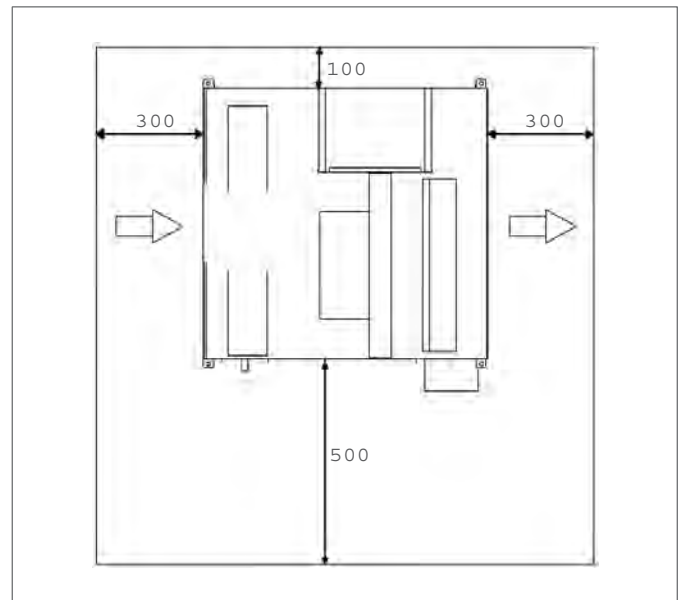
Dimensiones del registro de inspección con los componentes señalados
